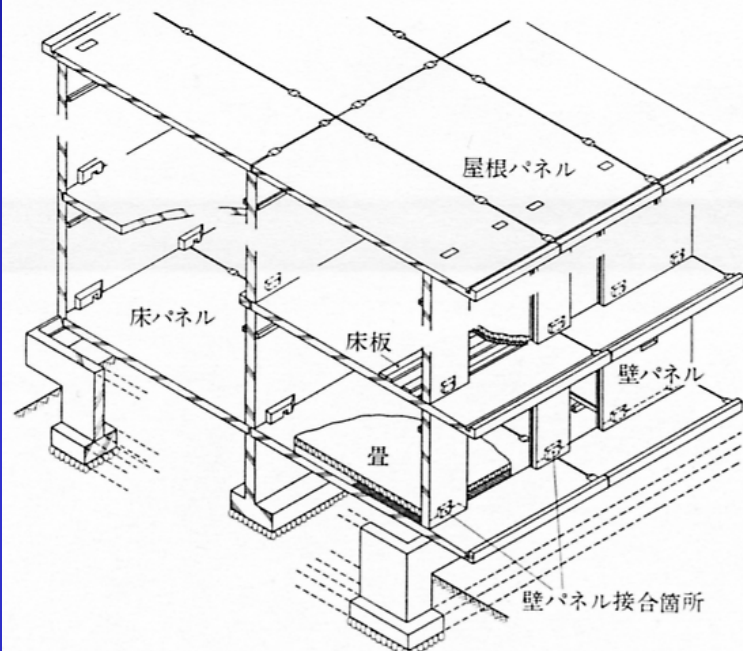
壁式プレキャスト鉄筋コンクリート構造
